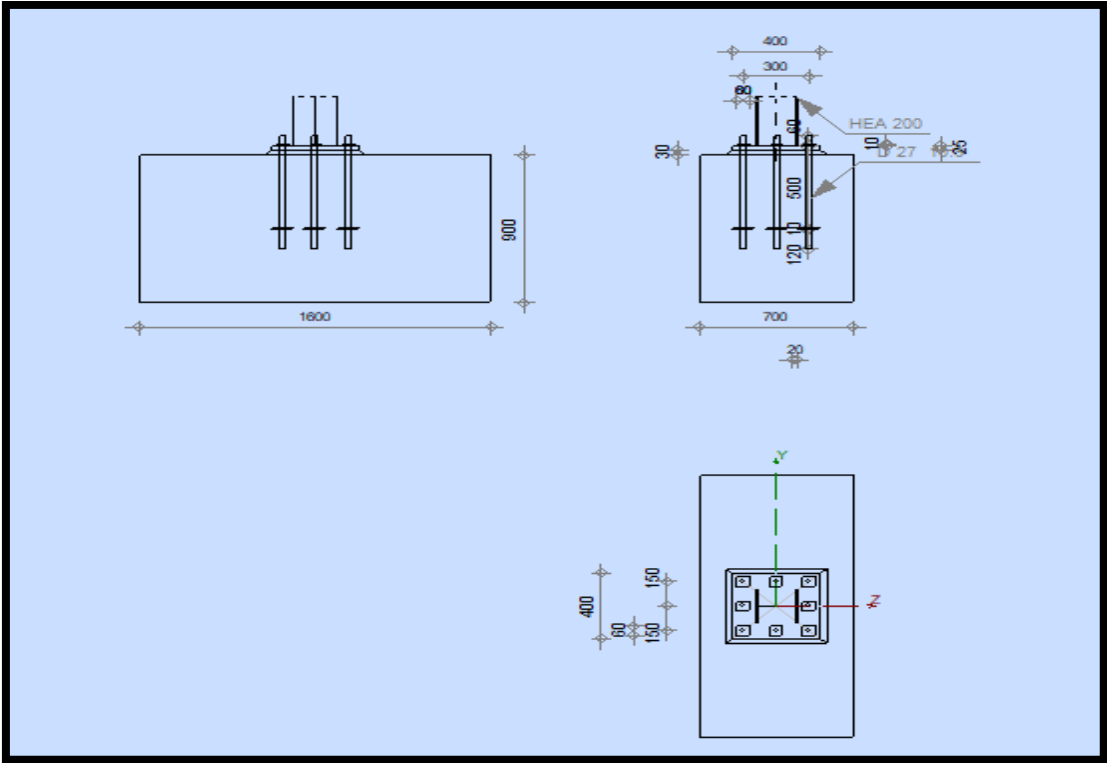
schéma d'assemblage pieds de poteau encastré.
